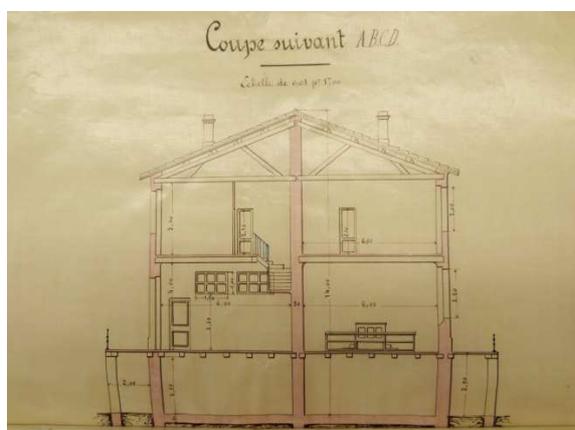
Projet de construction d'une maison d'école avec mairie, coupe suivant ABCD, Angeli (conducteur des Ponts et Chaussées).
